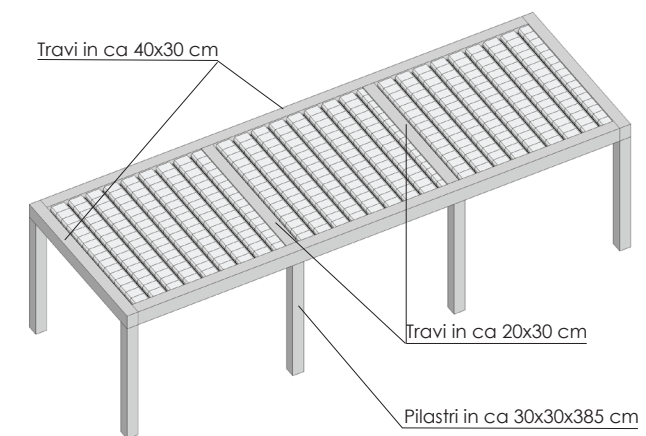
Assonometria della campata ricostruita in travi e pilastri in cemento armato e solaio in laterocemento; Fonte: elaborazione personale;
